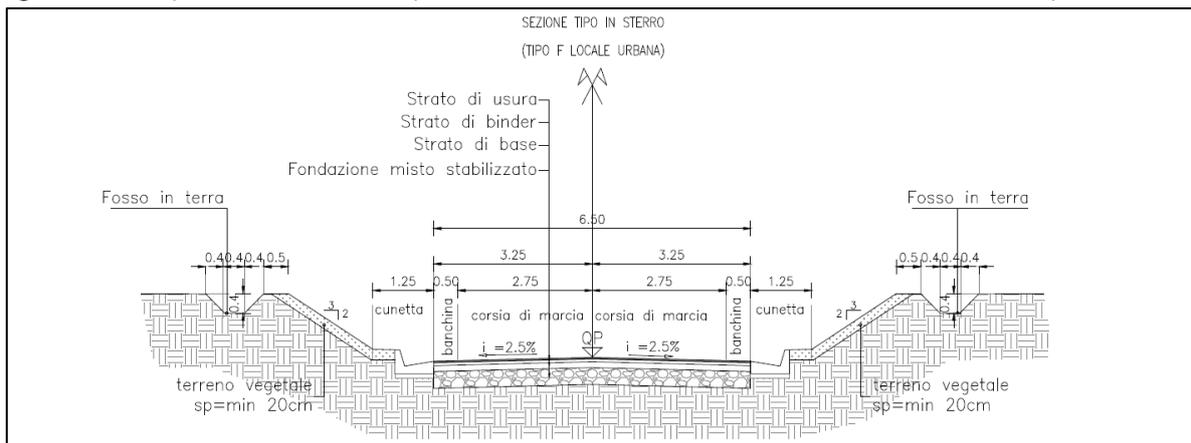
Sezione tipo in trincea della viabilità da adeguare
